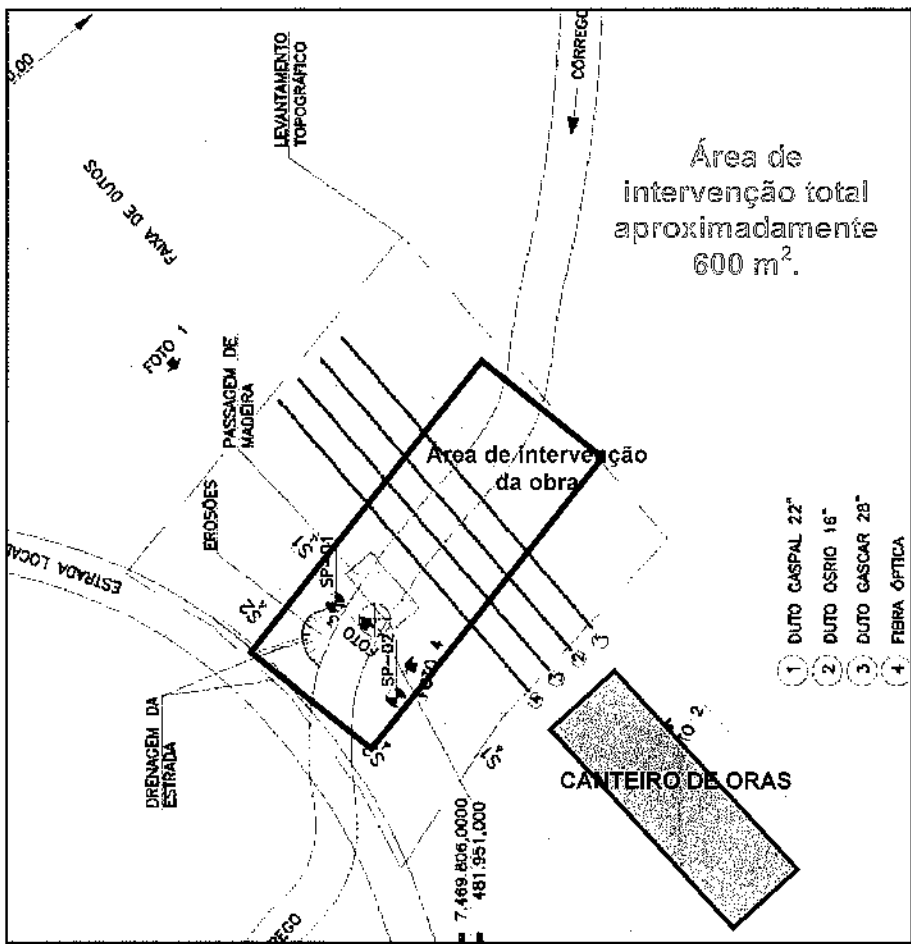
Croqui com a área de instalação do canteiro de obras, dentro dos limites da faixa de dutos.
